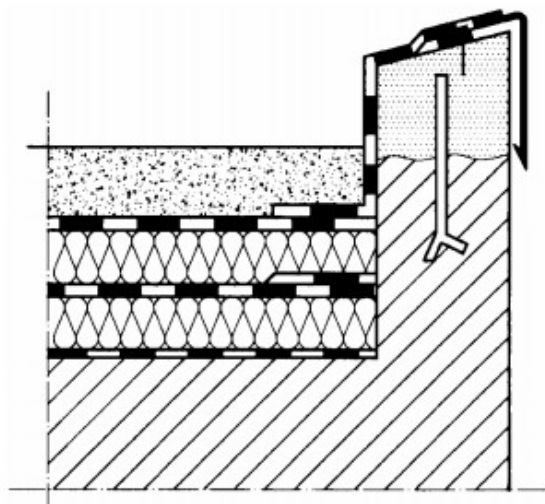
Exemple de rehaussement d'un acrotère de hauteur insuffisante
